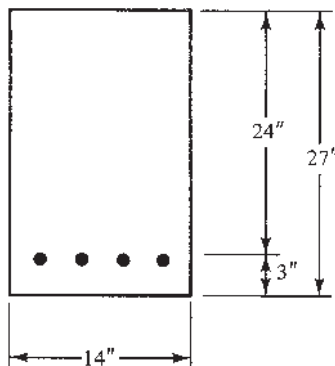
Sección transversal de la viga del Ejemplo 8.2
